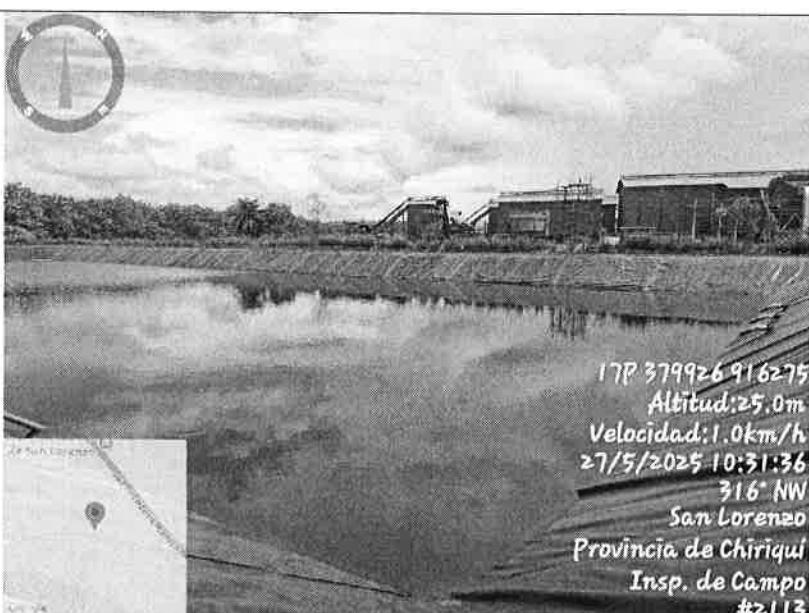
Vista parcial del área de ubicación de la planta de tratamiento, fuera del polígono.
